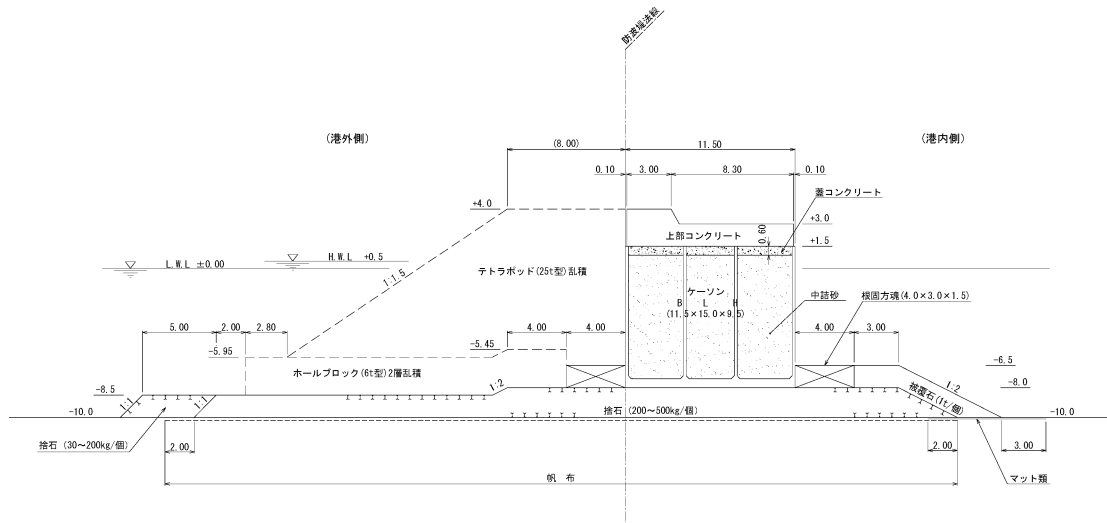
標準断面図 (防波堤Ⅳ, 単位: m)
